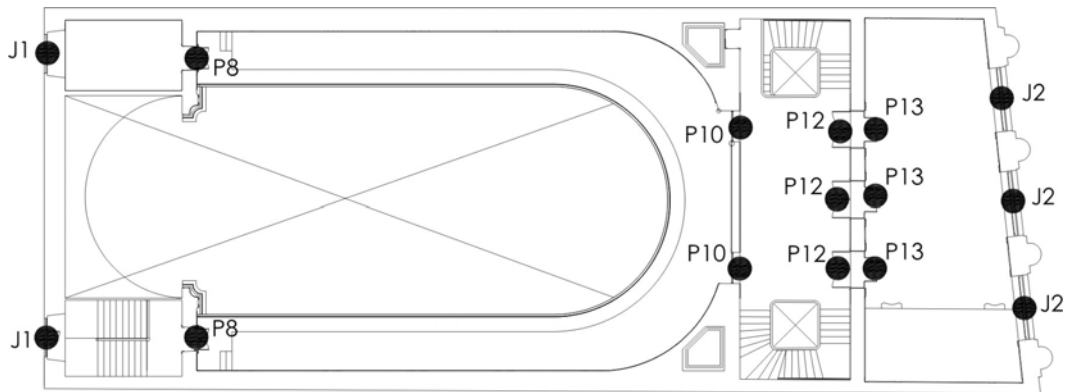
Planta baixa - localização das esquadrias - caderno de esquadrias – 3 pavimento, 2006.
